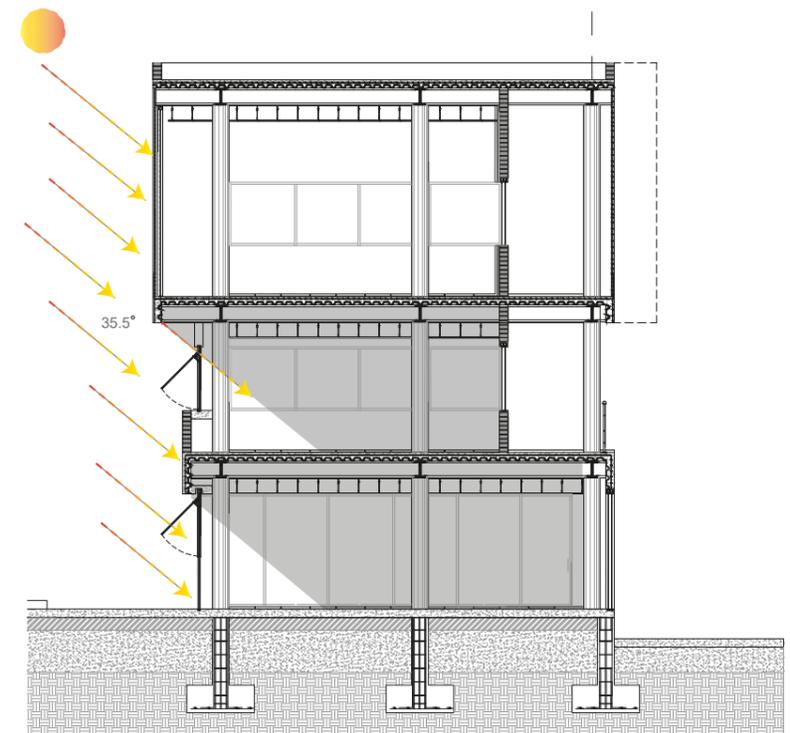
Análisis de protección muros de fibrocemento perforados fachada norte -sur.
